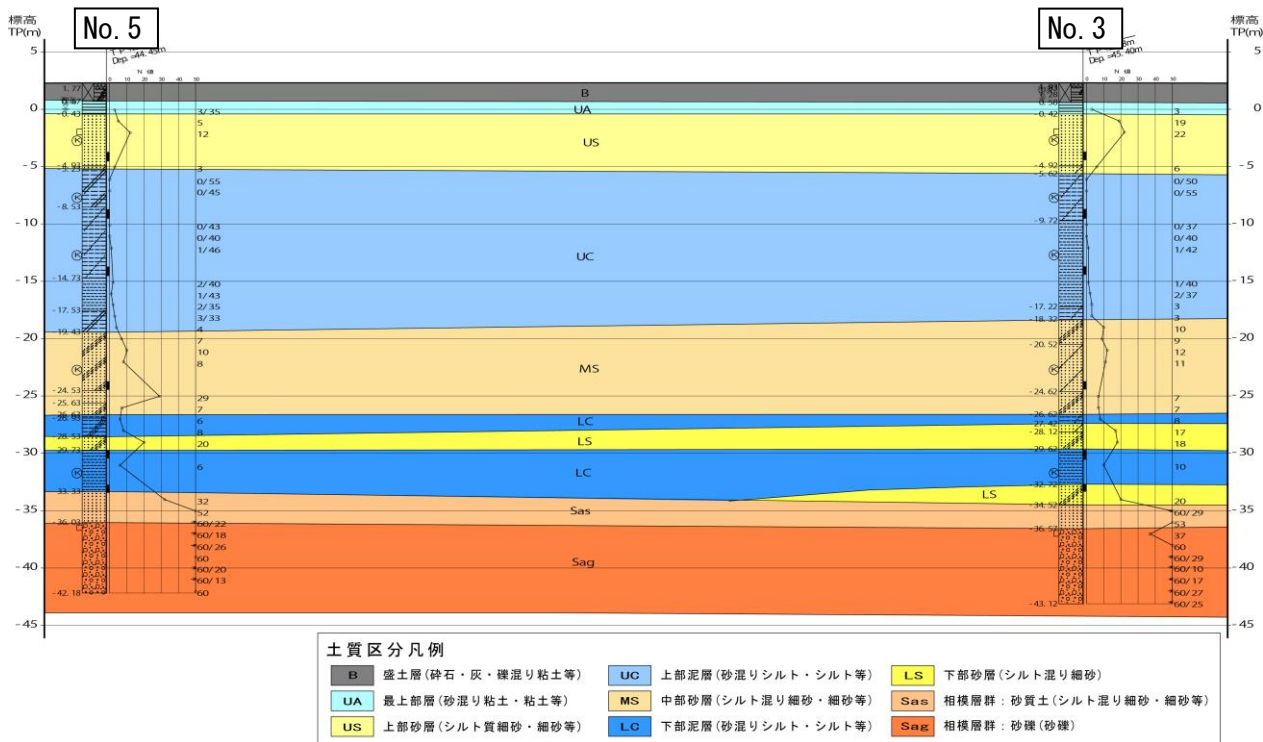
(3) 想定地質断面図 (断面 3)
